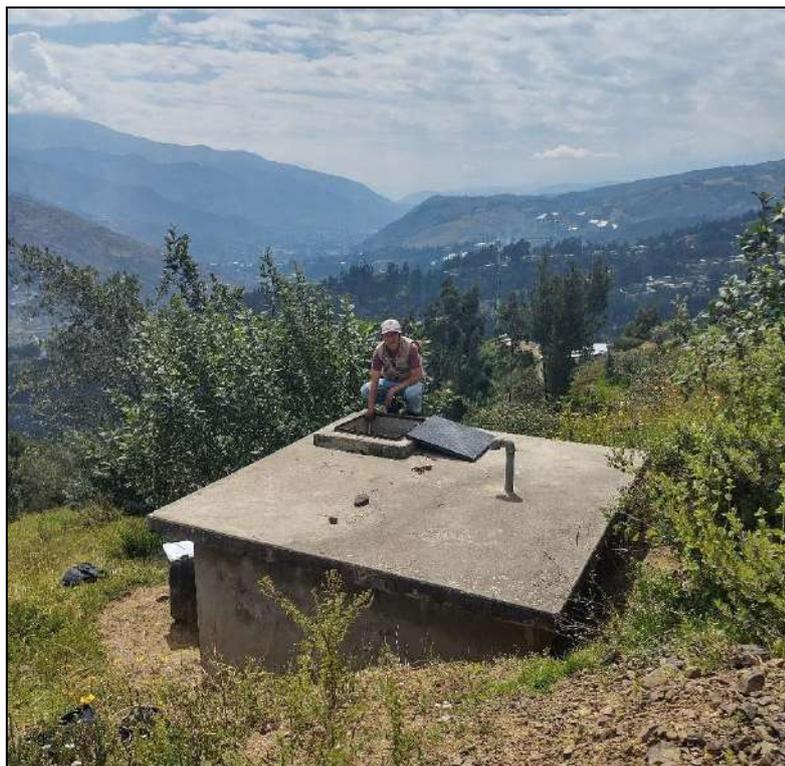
, Foto N° 09 – Caja de válvulas reservorio
